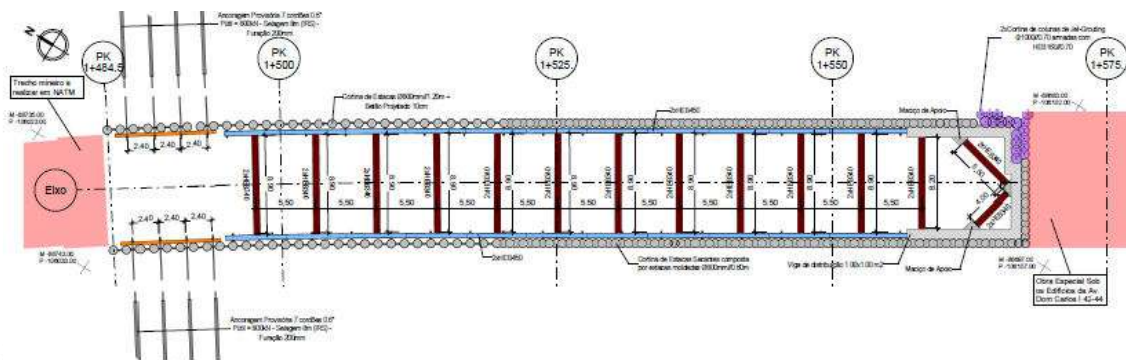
Contenção em Cortina de Estacas 800mm – Planta.
